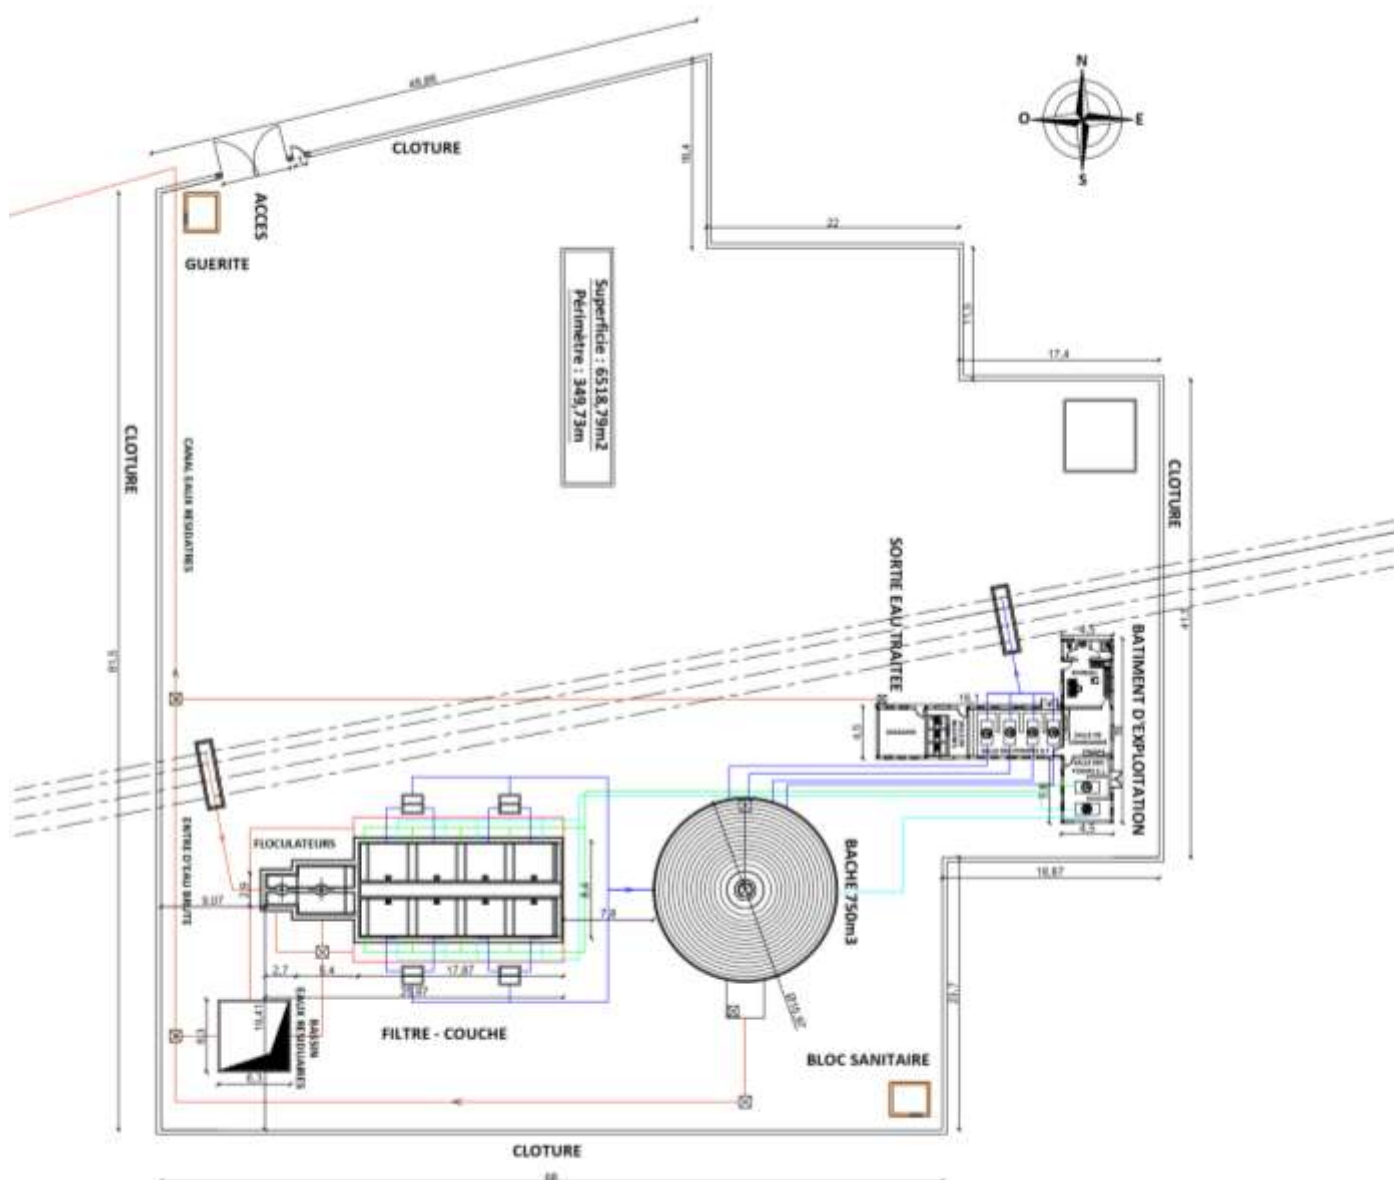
Plan de masse de la station de traitement d'Ambatofinandrahana
